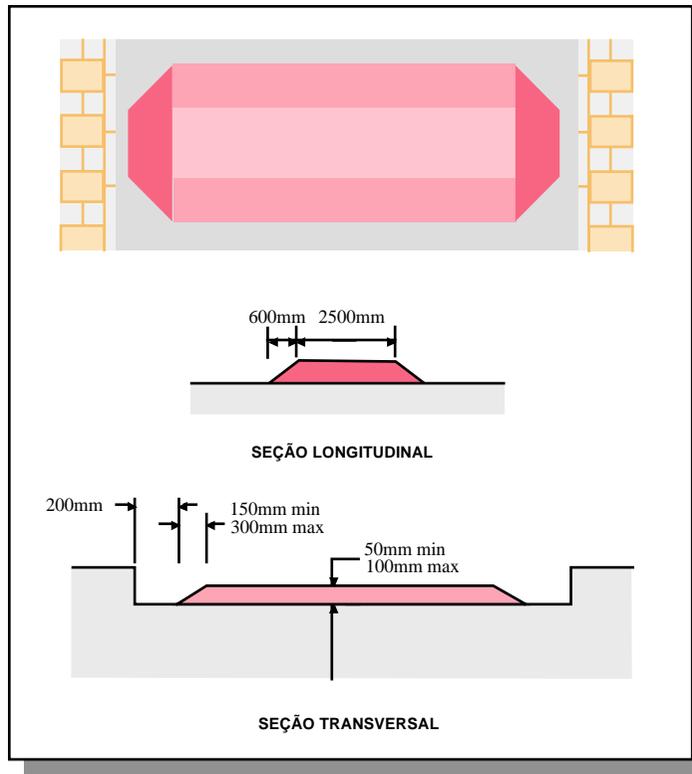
Detalhe de plataforma: planta, seções transversal e longitudinal
